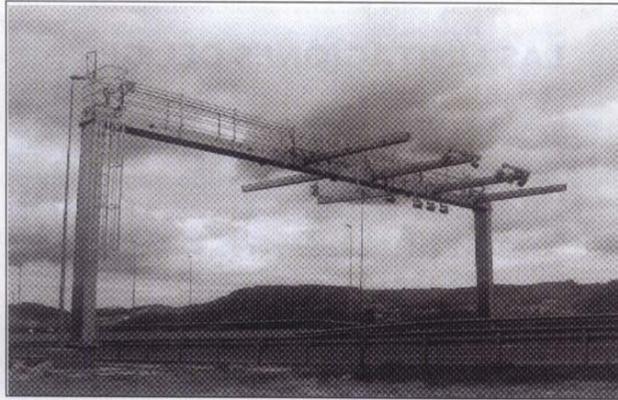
Pórtico DSRC con cámaras de vigilancia en el Sistema Austríaco.
